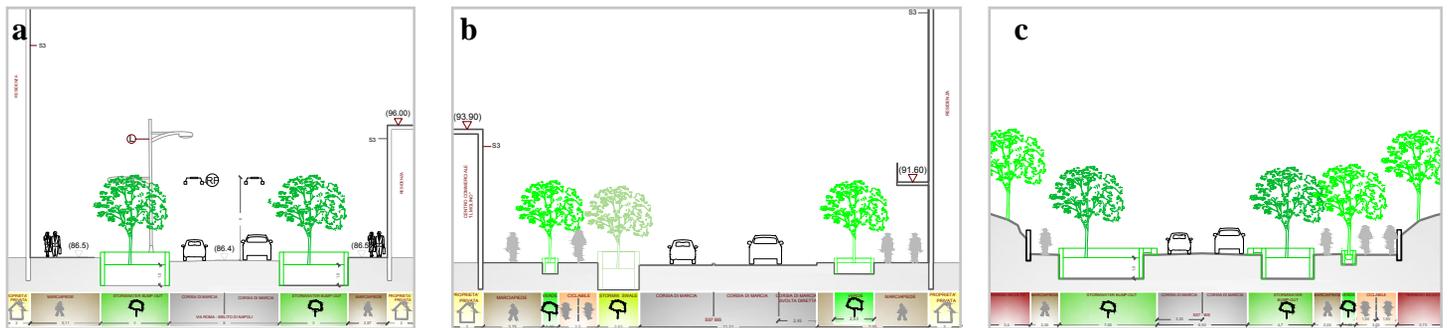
, b, c - Sezioni stradali tipo di progetto / *Road sections project type* (Source: Authors' elaboration).
